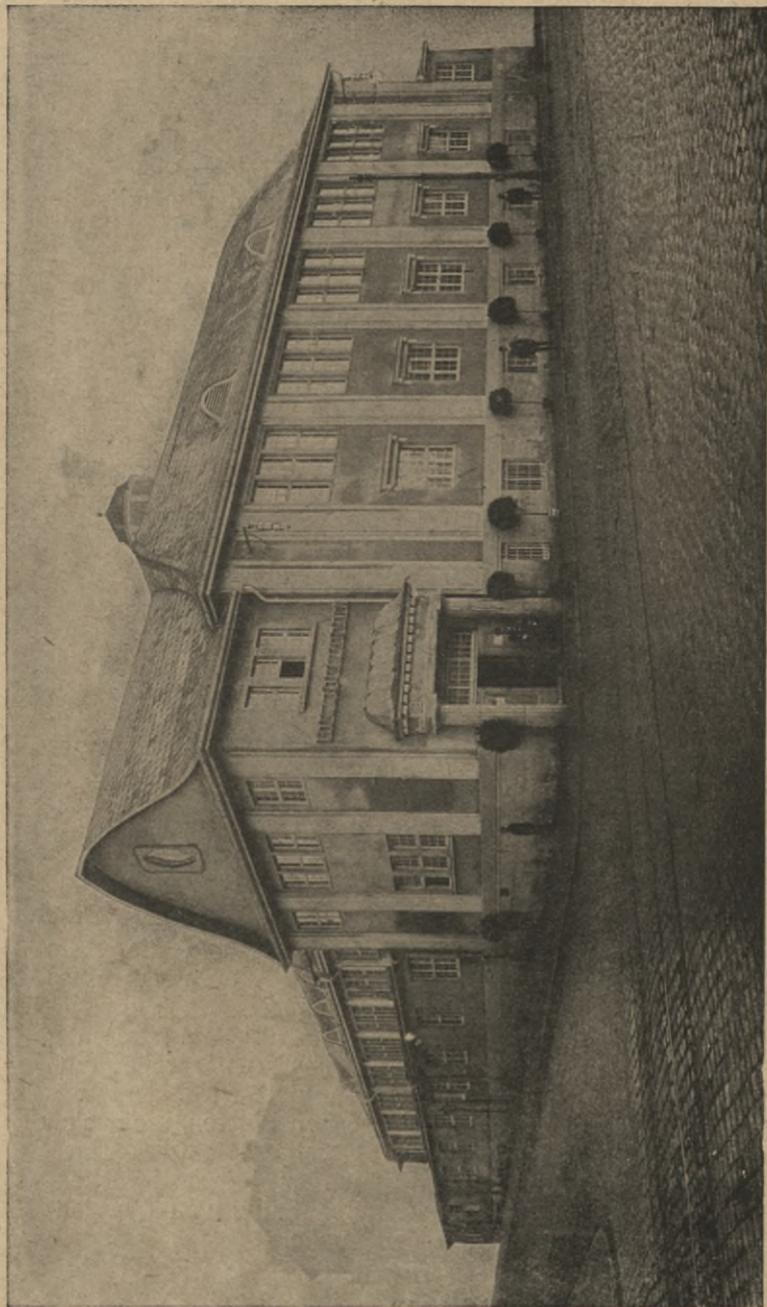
Rollschuhbahn Stuttgart mit Eternit eingedeckt.
